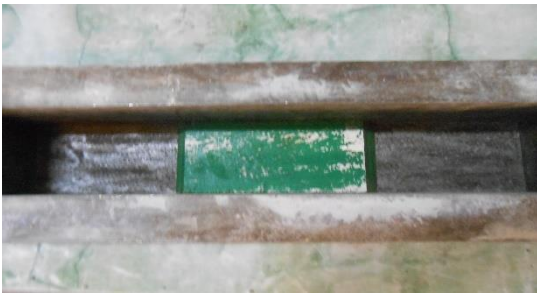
Moule éprouvette de dimension 10×10×50cm
